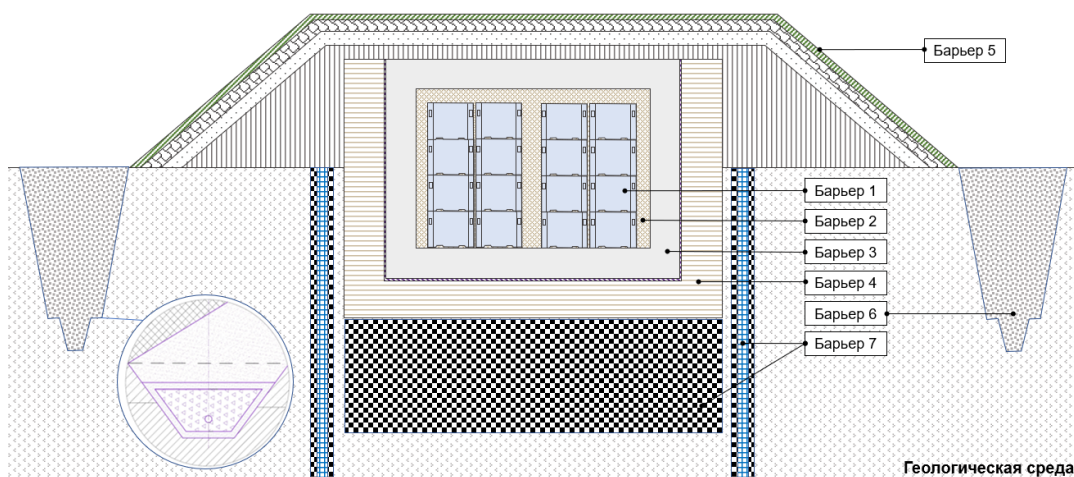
Система инженерных барьеров безопасности ППЗРО [48]: 1 барьер – контейнеры с РАО, 2 барьер – буферный материал на основе природных глин, 3 барьер – бетонные сооружения стен, дна и перекрытий модульных сооружений (МС), 4 барьер – глиняный экран и бентонитовые маты по периметру МС, 5 барьер – покрывающий гидроизолирующий экран, 6 барьер – дренажная система, 7 барьер – шпунтовая и грунтоцементная завесы.
